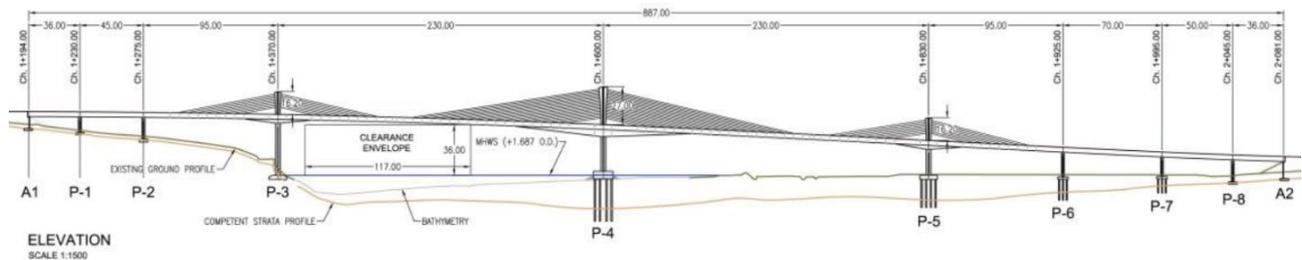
alzado con la distribución de vanos y pilas de la estructura.
